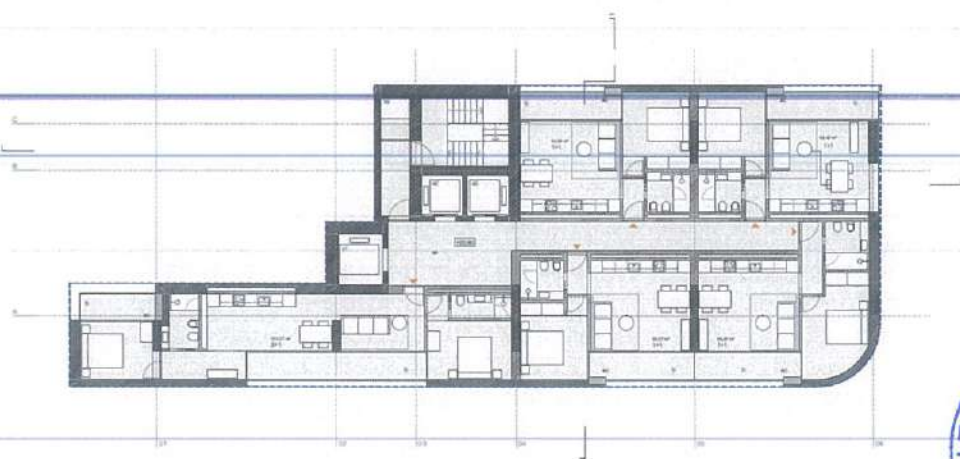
Planimetria e katit TIP te banimit per katet 6, 20
